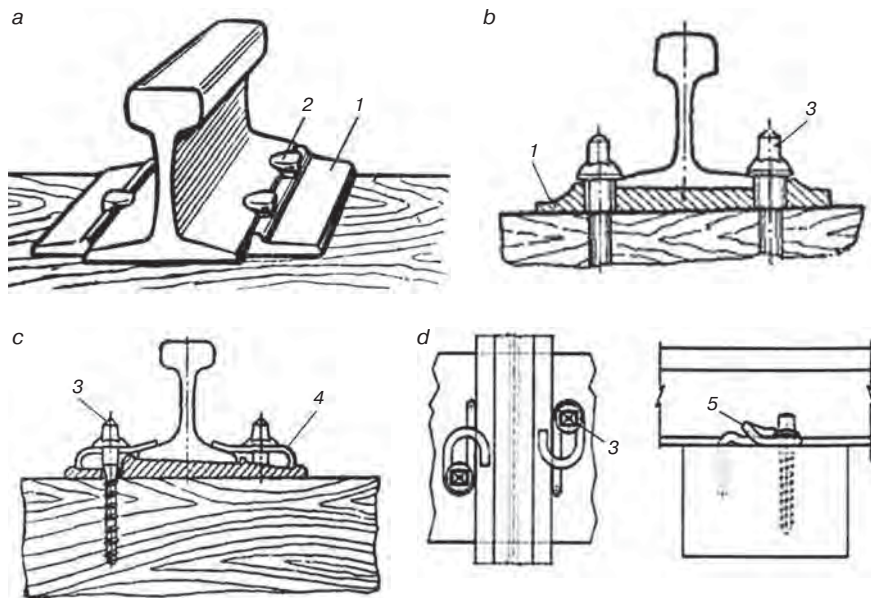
Схема промежуточных рельсовых креплений нераздельного типа в ж/д пути с деревянными шпалами [83, 103]: *a* – костыльное; *b* – жесткое шурупное; *c* – шурупное с плоской клеммой; *d* – шурупное с витковой клеммой; 1 – подкладка; 2 – костыль; 3 – шуруп; 4 – плоская клемма; 5 – витковая клемма
